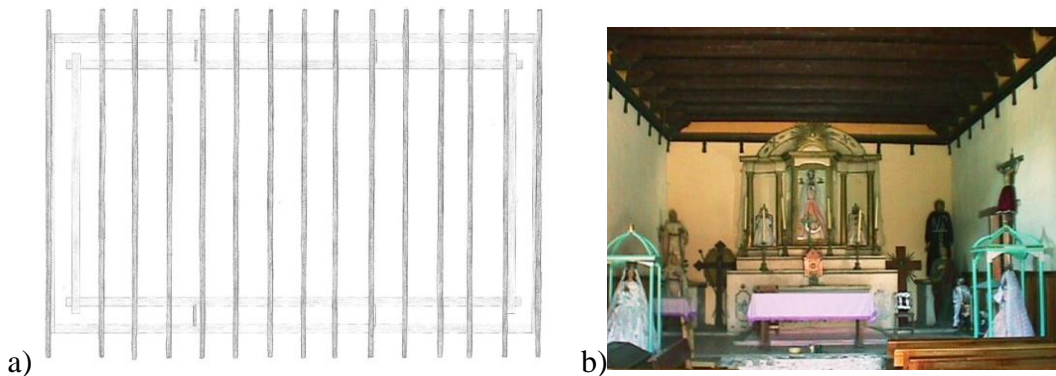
a) Planta del sistema de vigas y b) Plafón del interior de la capilla.
